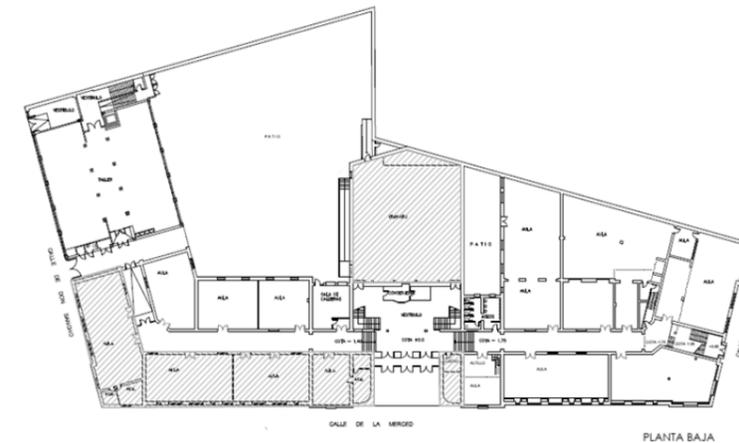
Planimetría del proyecto simplificado de obras de reformas interiores, Área Técnica de Construcciones y Equipamientos de la Dirección Provincial de Valladolid.
